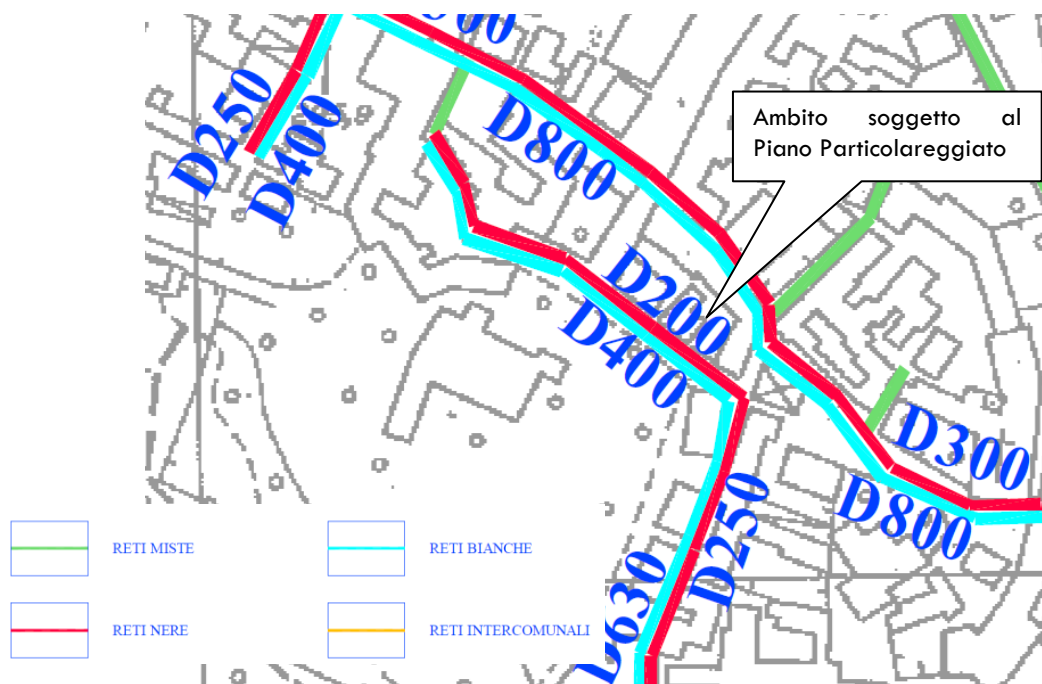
Estratto PRG vigente, Tavola 1/A "Rete fognaria"
